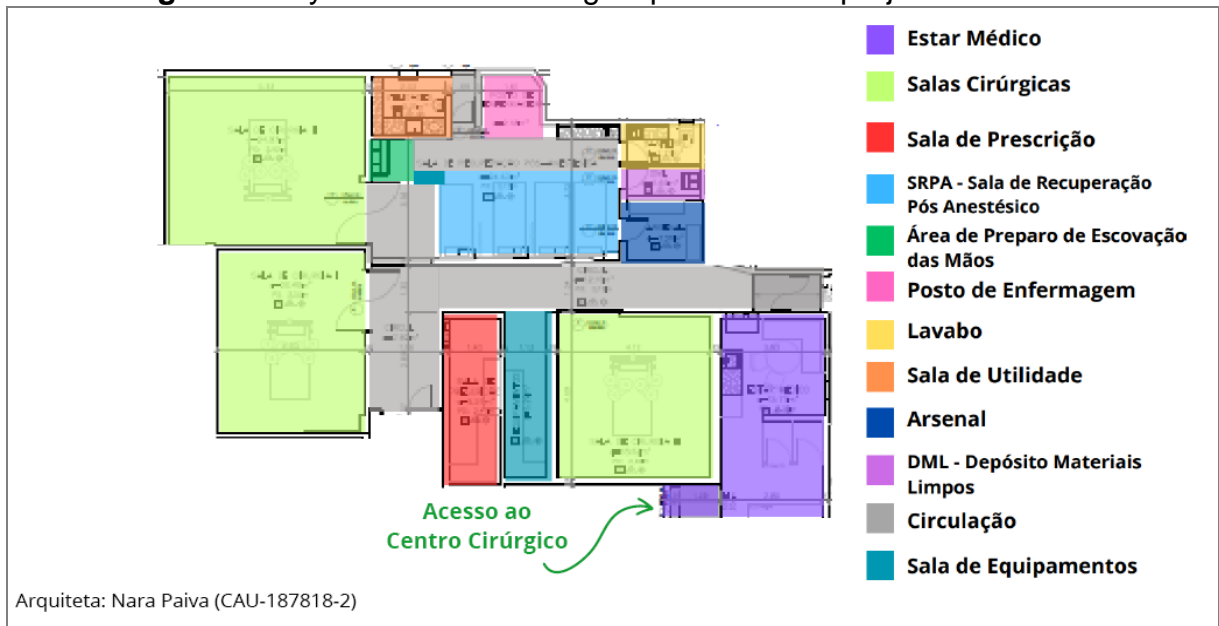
Planta de layout do centro cirúrgico antes da reforma
